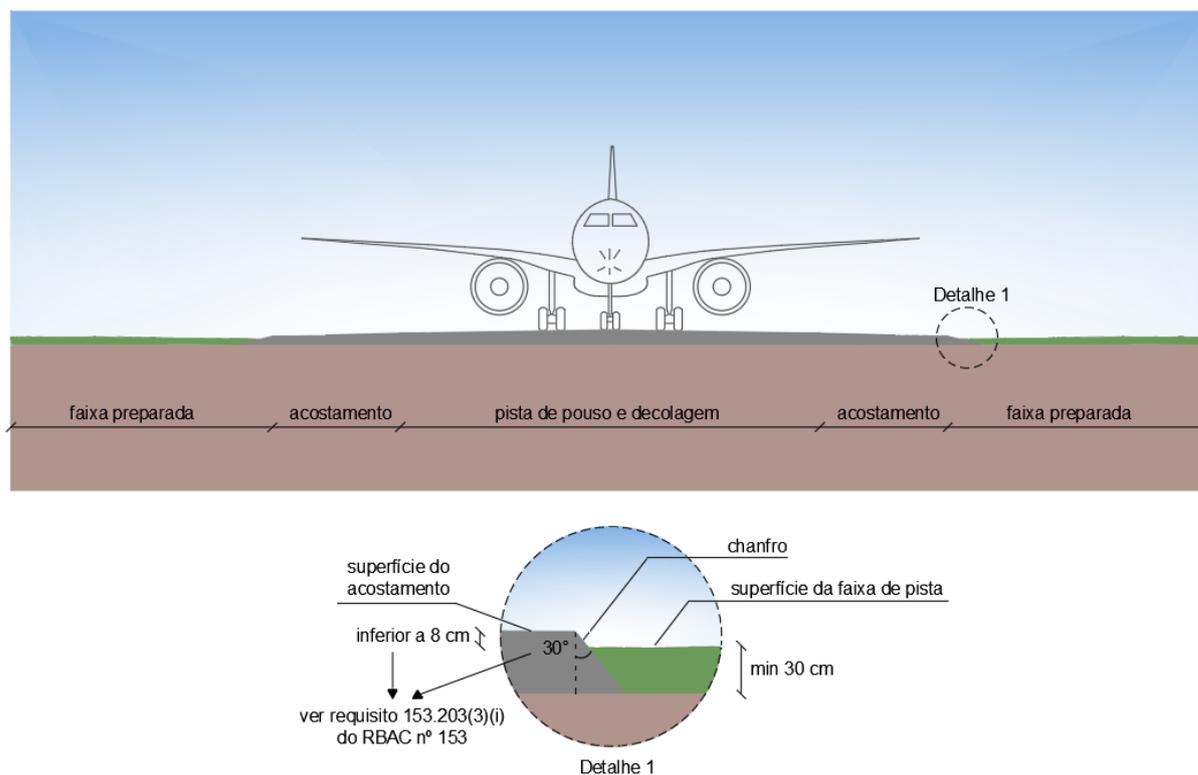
Chanfro entre a superfície da faixa de pista, acostamento ou zona de parada e a superfície da faixa de pista.
